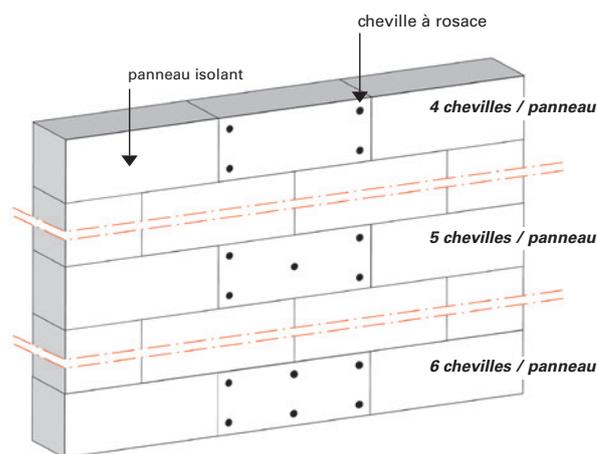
Fixation des panneaux isolants par chevilles – Disposition en plein (exemples)
